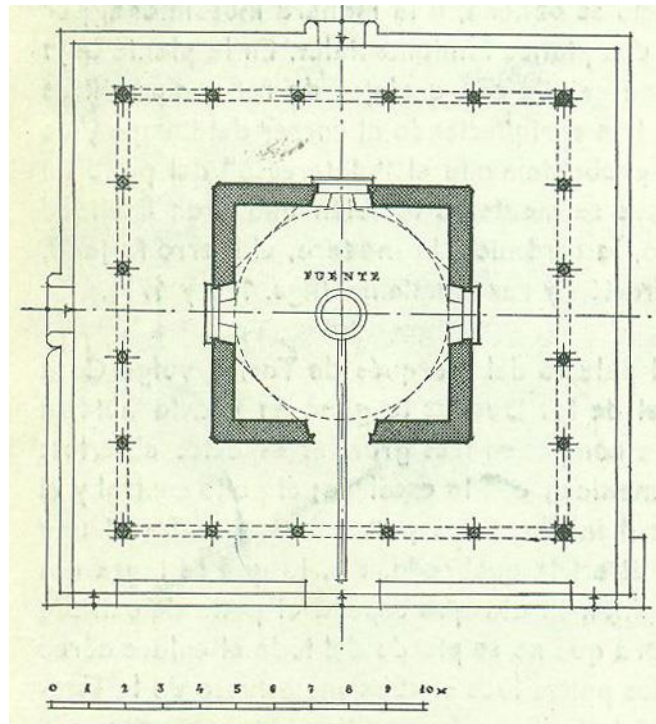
Planta del Pabellón de Calor V en el Alcázar de Sevilla. Fuente: F. Chueca.1953.
